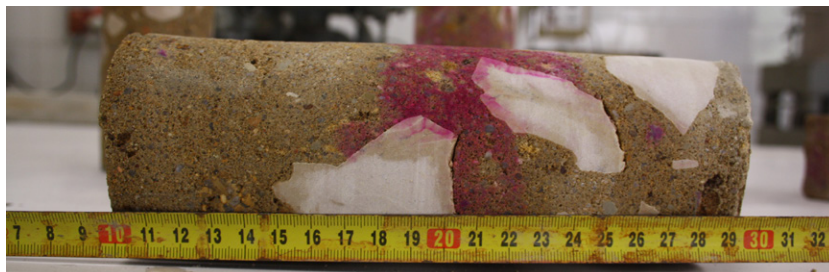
Muestras de testigos a los que se le ha aplicado en ensayo de fenolftaleína.
